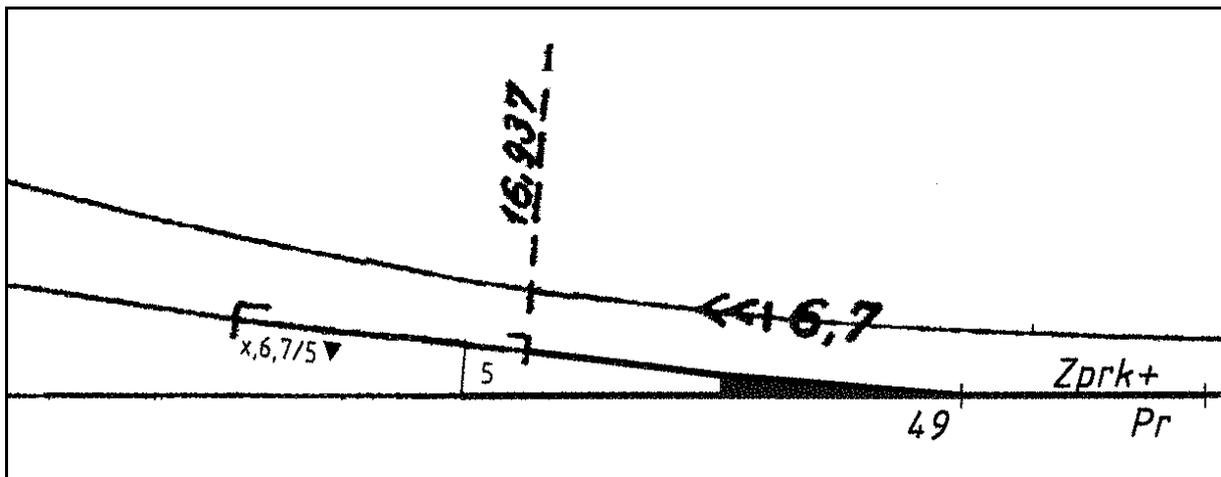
Auszug Lageplan (isolierte Schiene)
